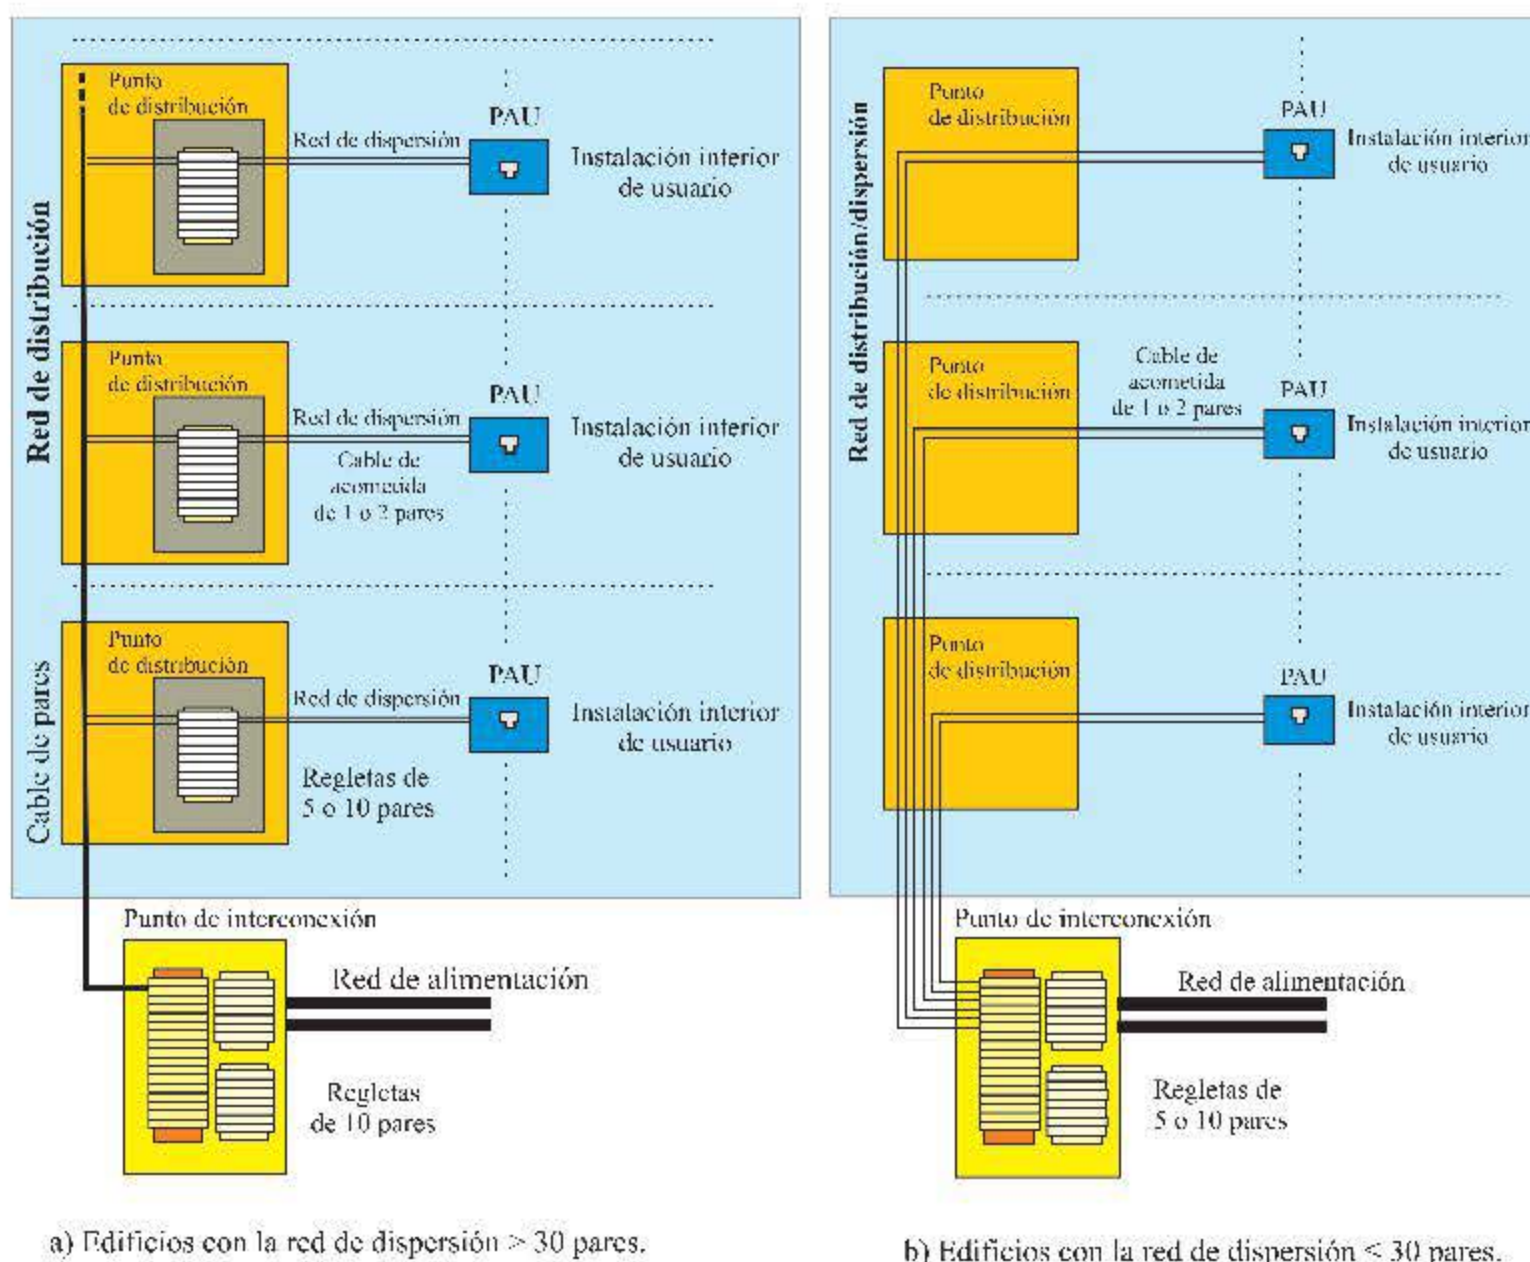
Tipologías de distribución de la red de cable de pares.
